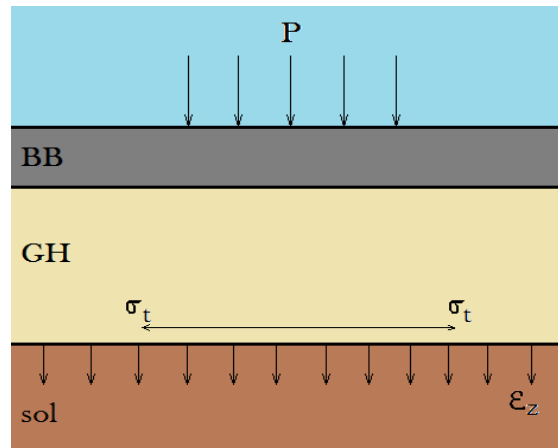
Fonctionnement d'une chaussée semi-rigide.
